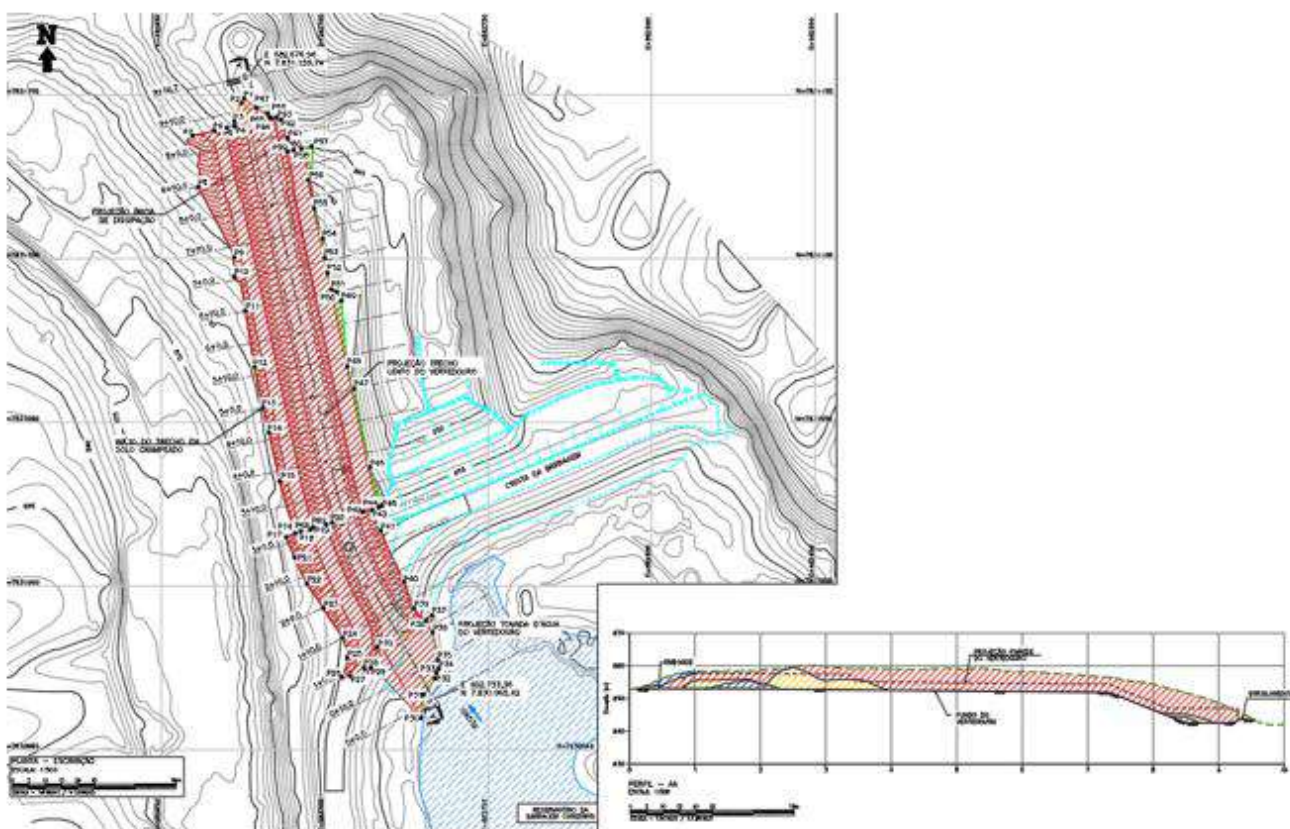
Planta de escavação – Fonte: 1850EE-X-83720 (CGF-E-BQ-DE-304)
